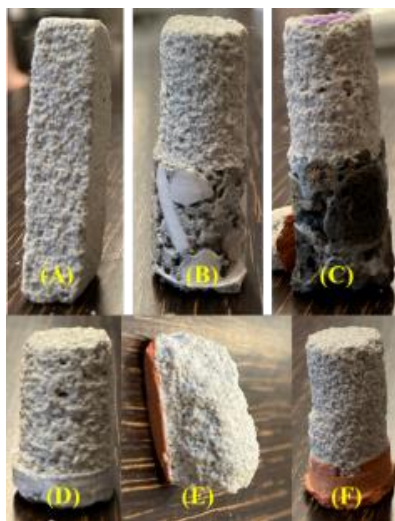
Amostras utilizadas no ensaio. (A) Argamassa endurecida no molde; (B) Argamassa/Bloco de betão; (C) Argamassa/Bloco de betão leve; (D) Argamassa/Placa de betão; (E) Argamassa/tijolo maciço; (F) Argamassa/Tijolo furado (diâmetro equivalente: 8-9 mm)
